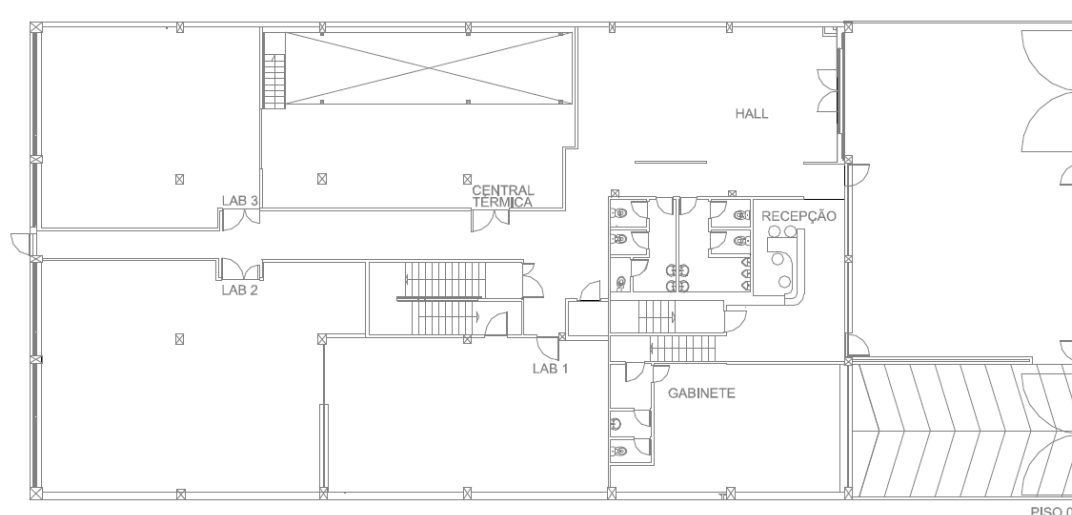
Planta do piso 0 do ECOTERMOLAB
